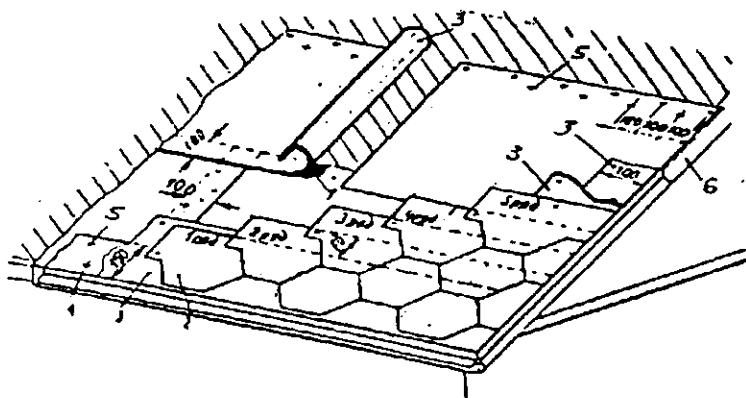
Устройство кровли из битумных плиток (шинглс)
